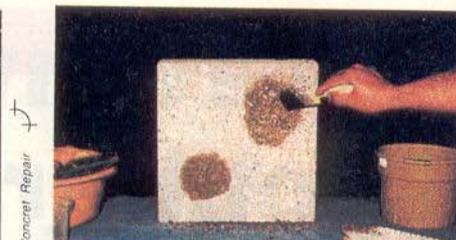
O segundo passo é passar um pincel umedecido para fazer combinar a recuperação com a superfície circundante.
